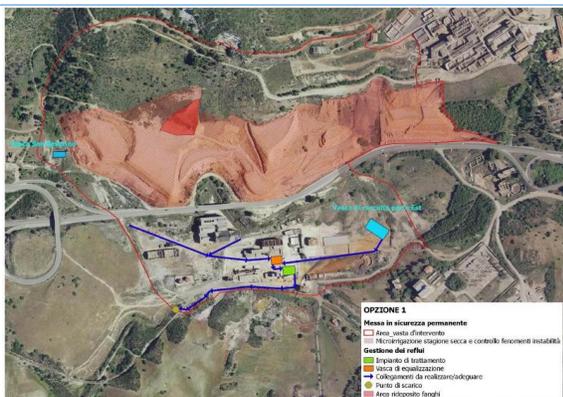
Planimetria degli interventi dell'opzione progettuale n. 1
